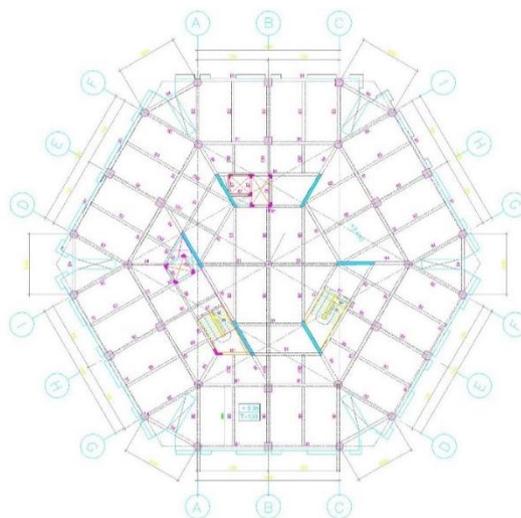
Denah struktur lantai tipikal Rancacili Silinder II
